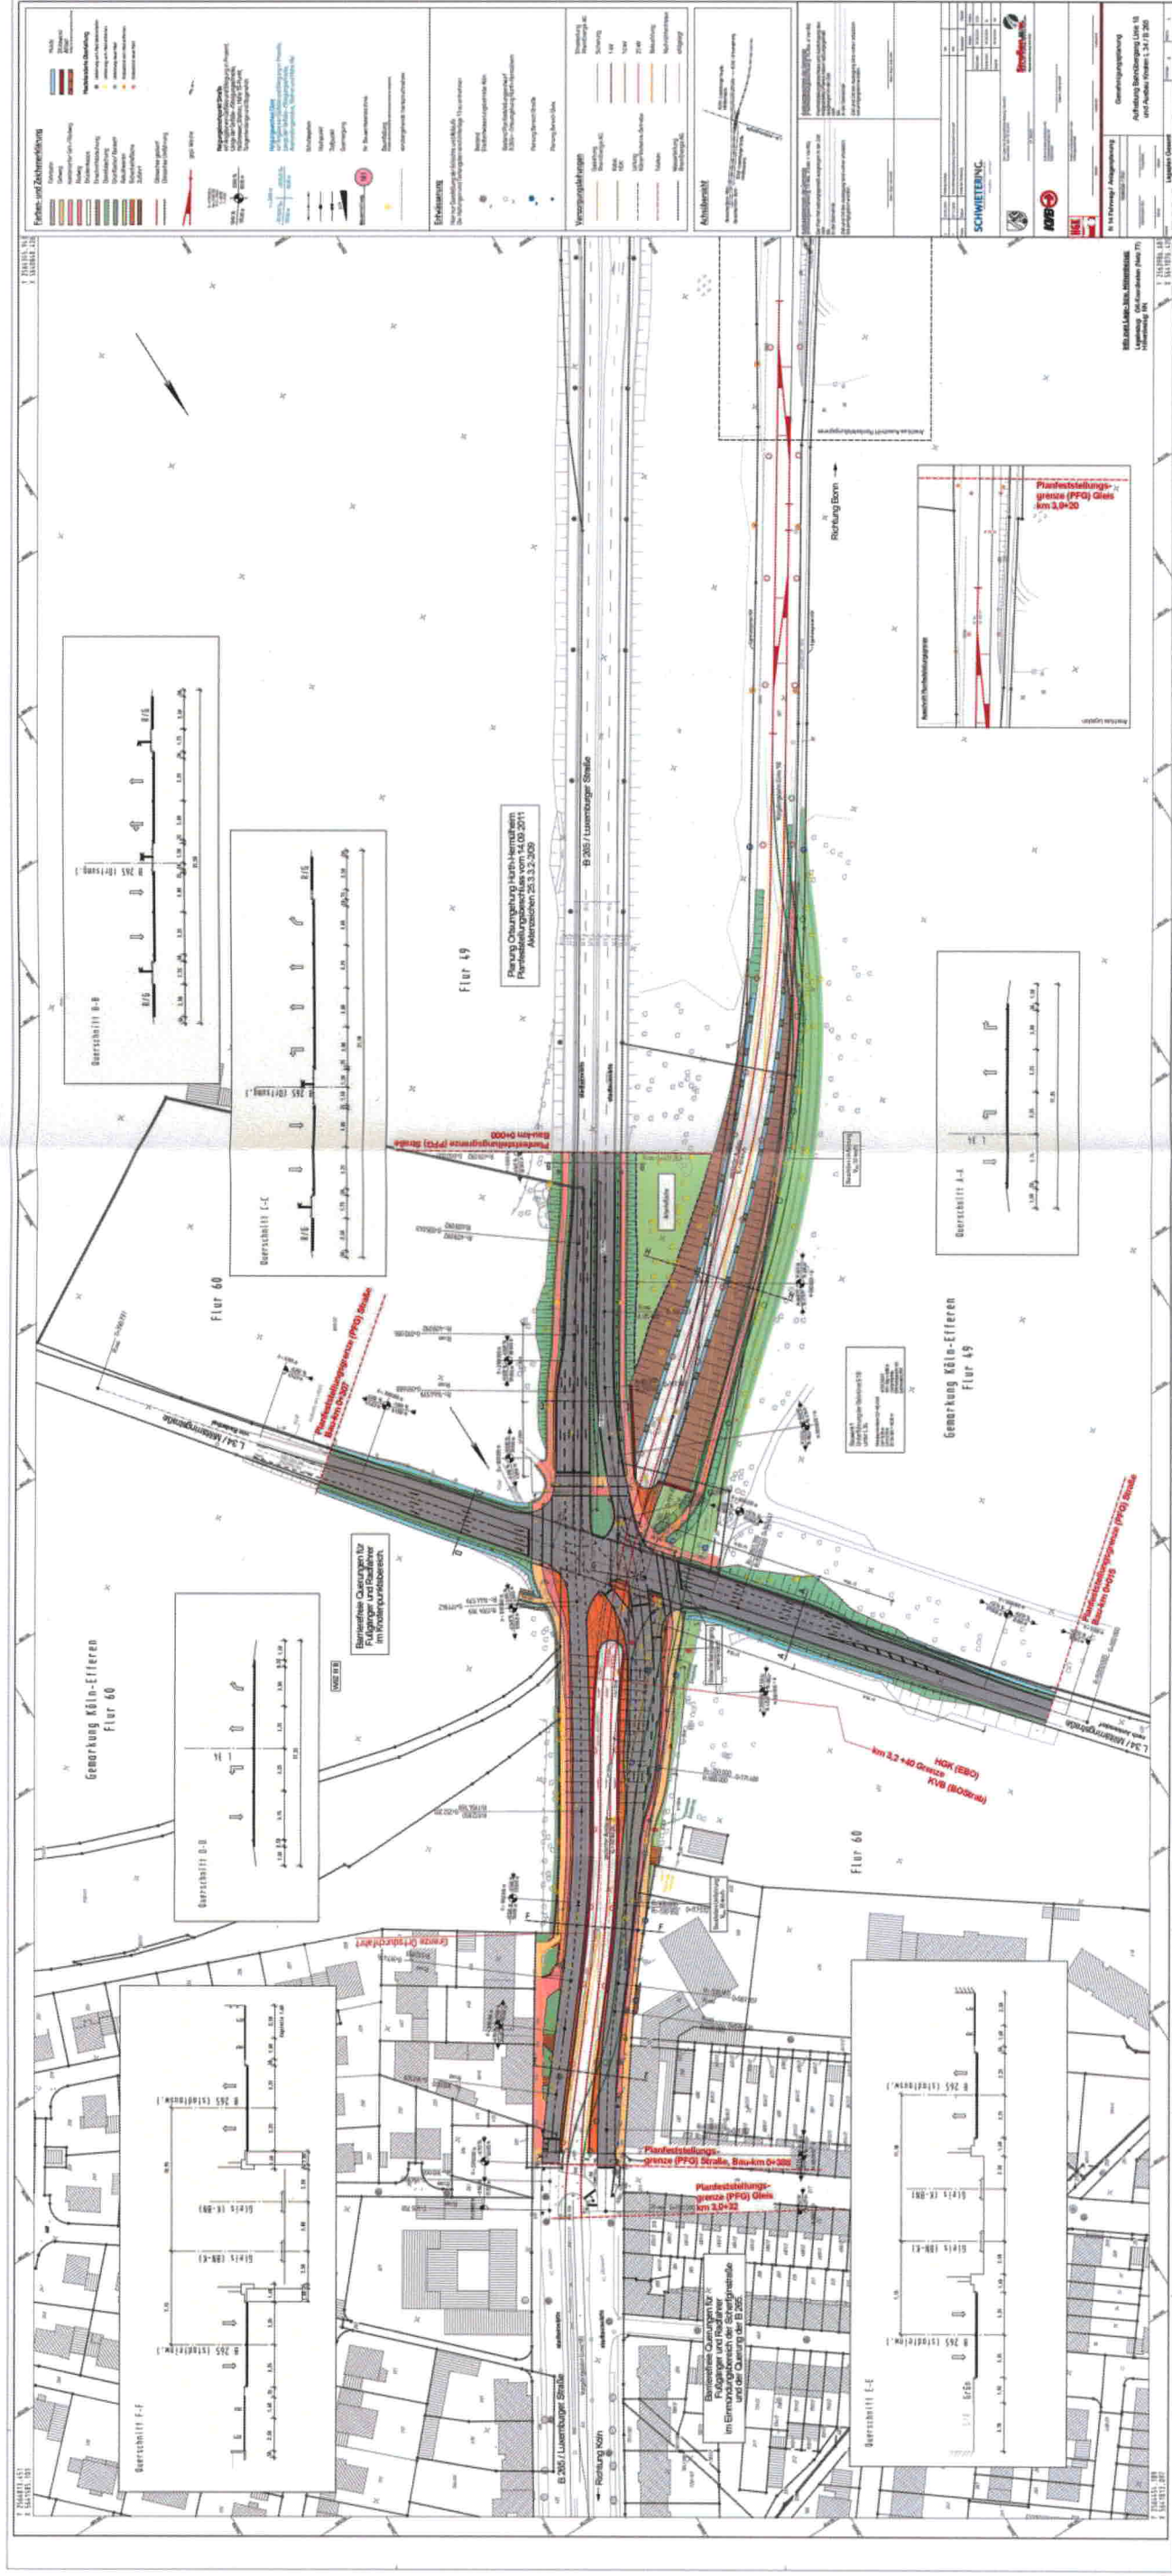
Übersichtslageplan zur Planfeststellung S 18 / B 265 / L 34 mit Bahnübergangsbeseitigung (Lageplan Gesamt, Stand: März 2019; Nordpfeil eingetragen; Quelle: Landesbetrieb Straßenbau NRW)
